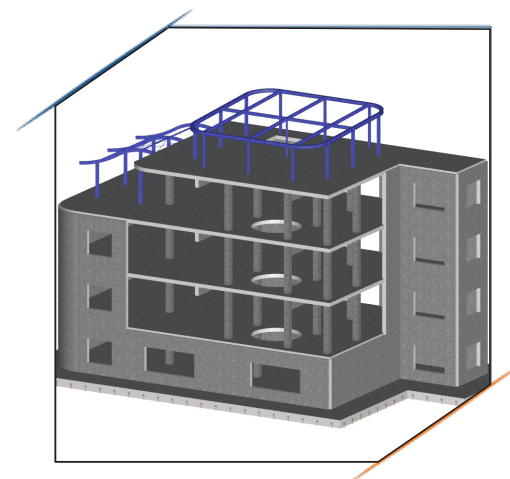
Elementos de Hormigón, (Hidalgo, 2022).
